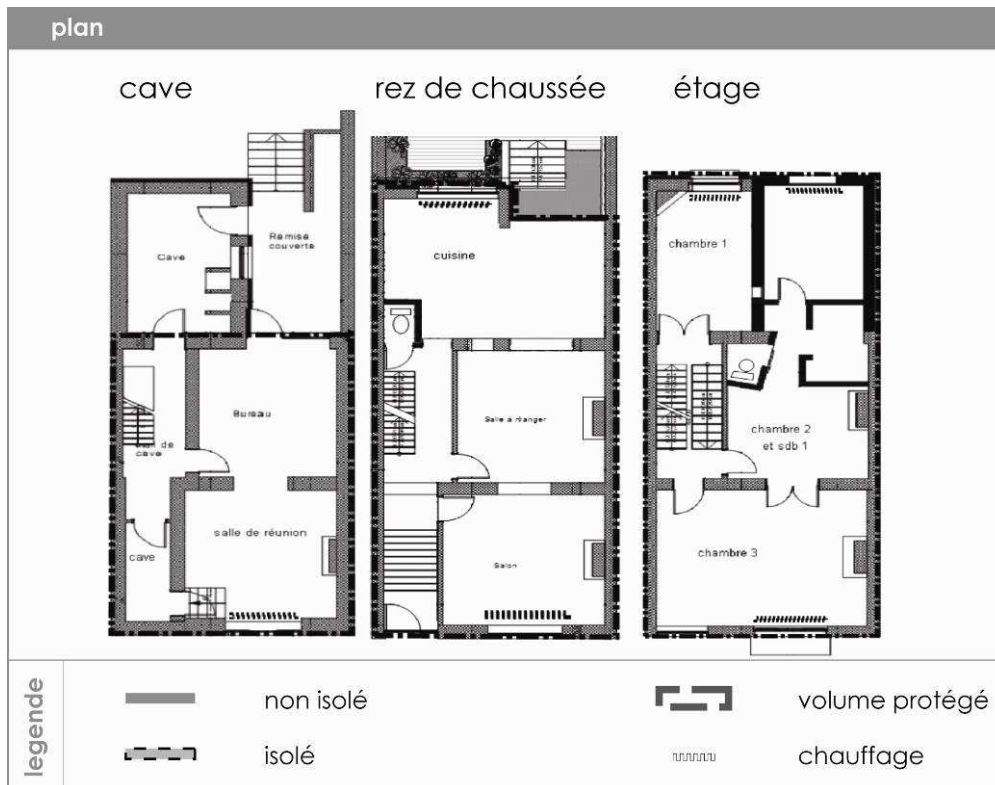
Plan au sol d'une maison de maître, avec de gauche à droite : sous-sol, rez-de-chaussée, premier étage
